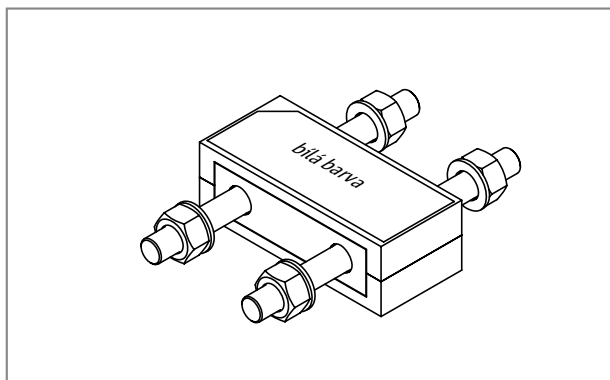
Schöck Isokorb® T typ S-N-D16: Pohled
